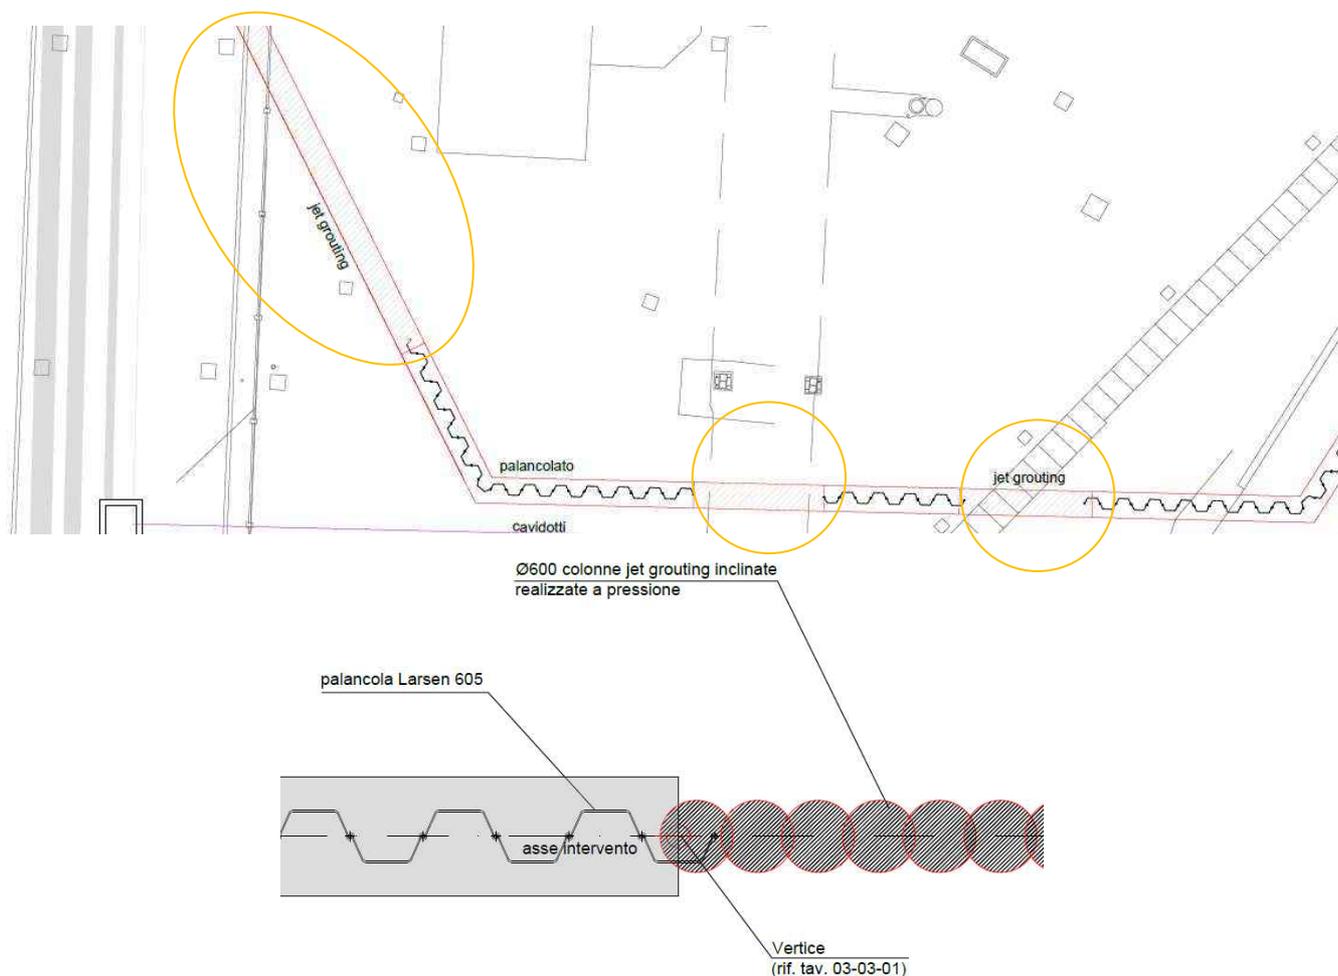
estratto planimetria tratti marginamento in Jet grouting (sopra), dettaglio connessione palancole-colonne JG (sotto)
